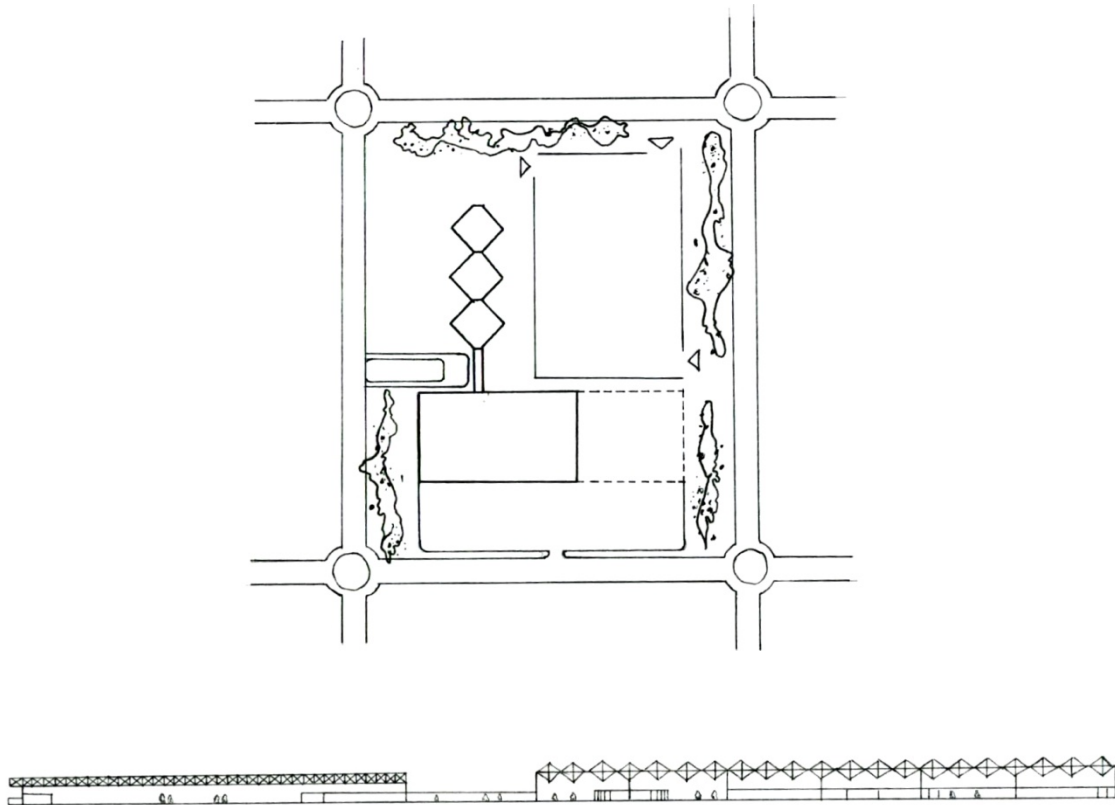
Planta de situação (acima) e fachada principal (abaixo) do Centro de Convenções.
